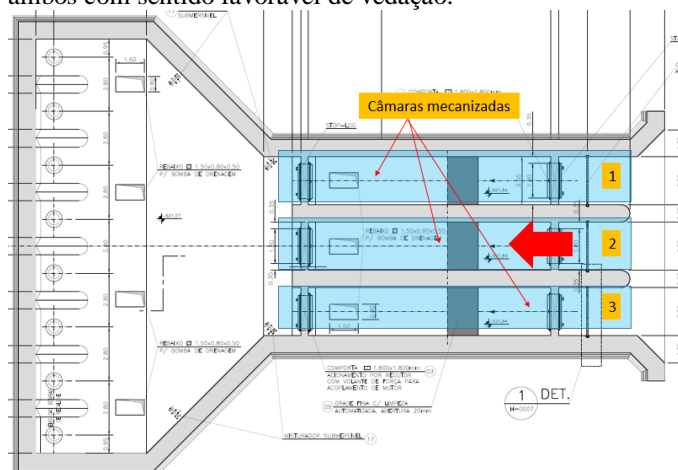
Camaras de grade mecanizada – Vista em Planta
